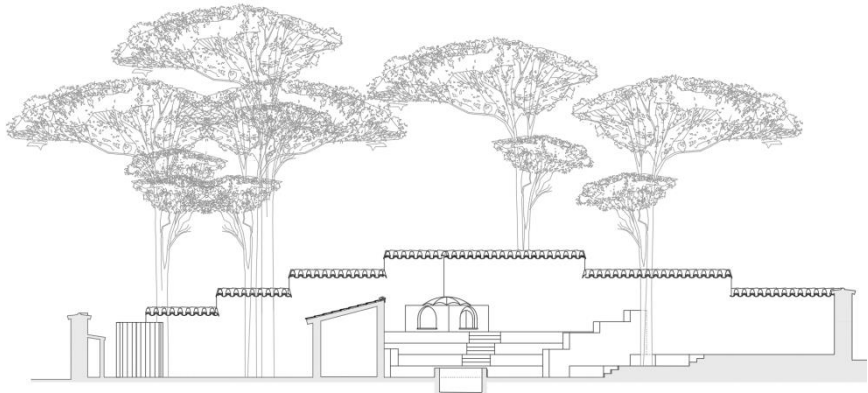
Sección B-B' Estado propuesto. Fuente propia.
